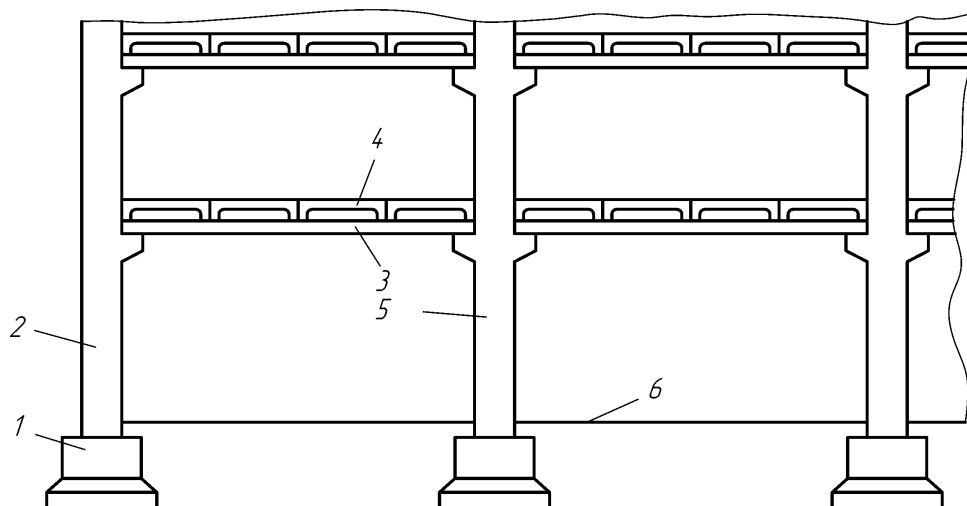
Схема многоэтажного здания: 1 – фундамент; 2 – крайняя колонна; 3 – ригель; 4 – ребристая плита перекрытия; 5 – средняя колонна; 6 – пол
